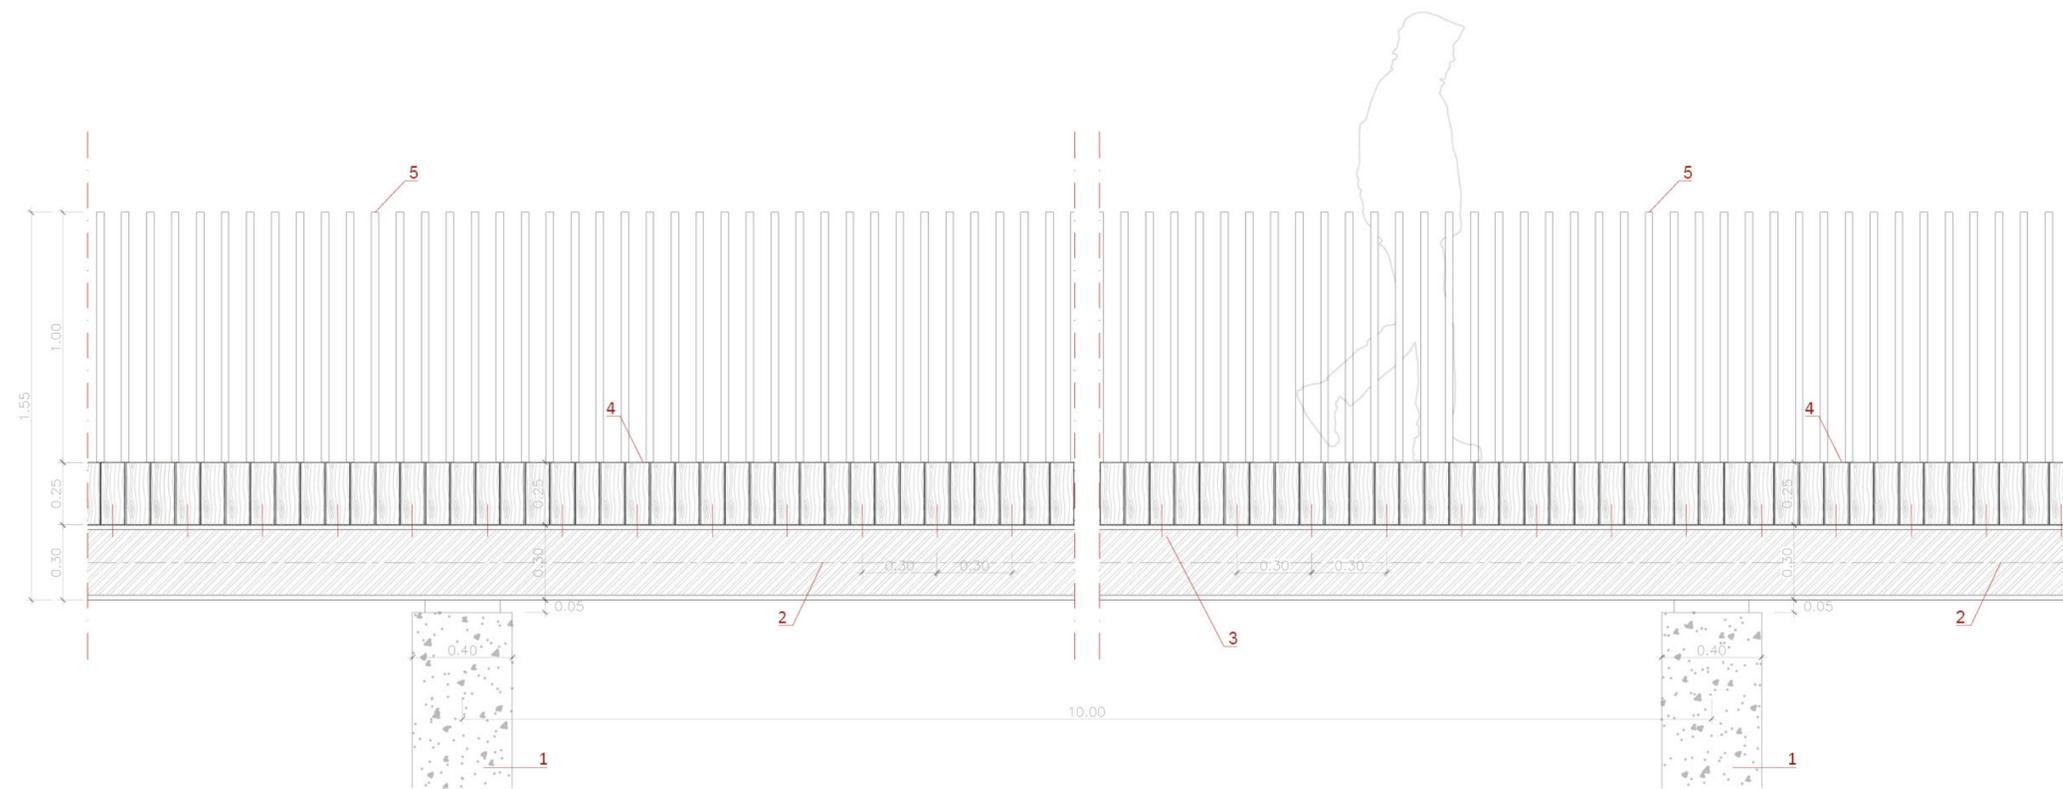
CORTE CONSTRUTIVO LONGITUDINAL A A'
